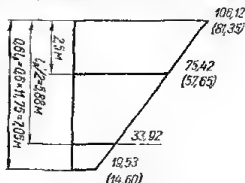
К определению поперечной силы в сечении по грани опоры. В скобках — величины усилий от нормативной нагрузки.
